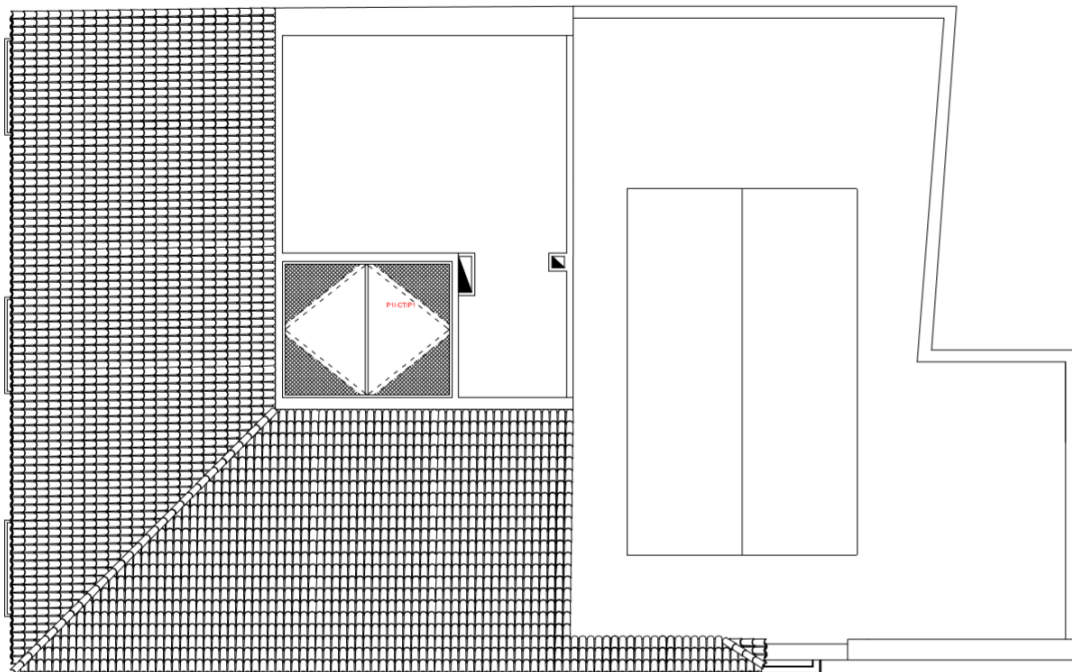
Plano planta cubierta. Estado actual 2019. Fuente: Elaboración propia, creación 21/06/2019
